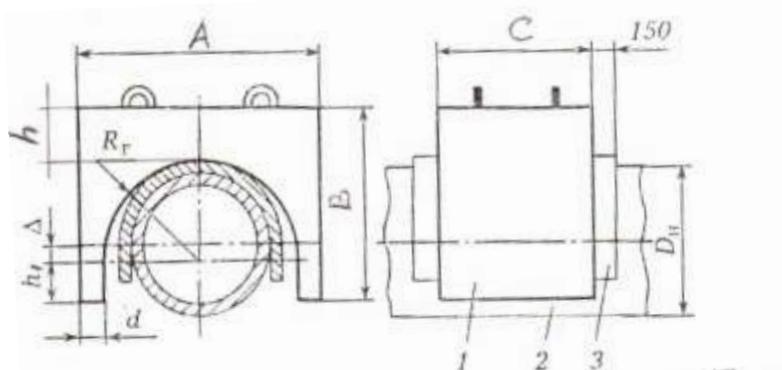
Железобетонный седловидный груз типа УТС:
